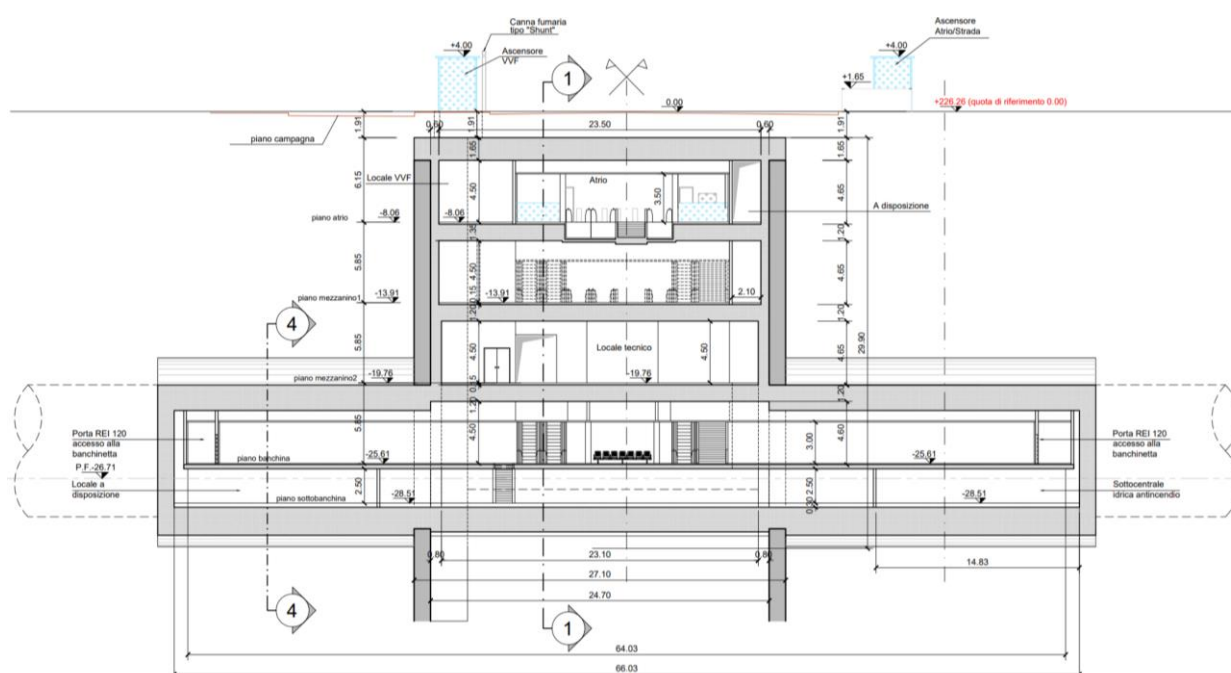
Sezione longitudinale della stazione tipologica con galleria di banchina
